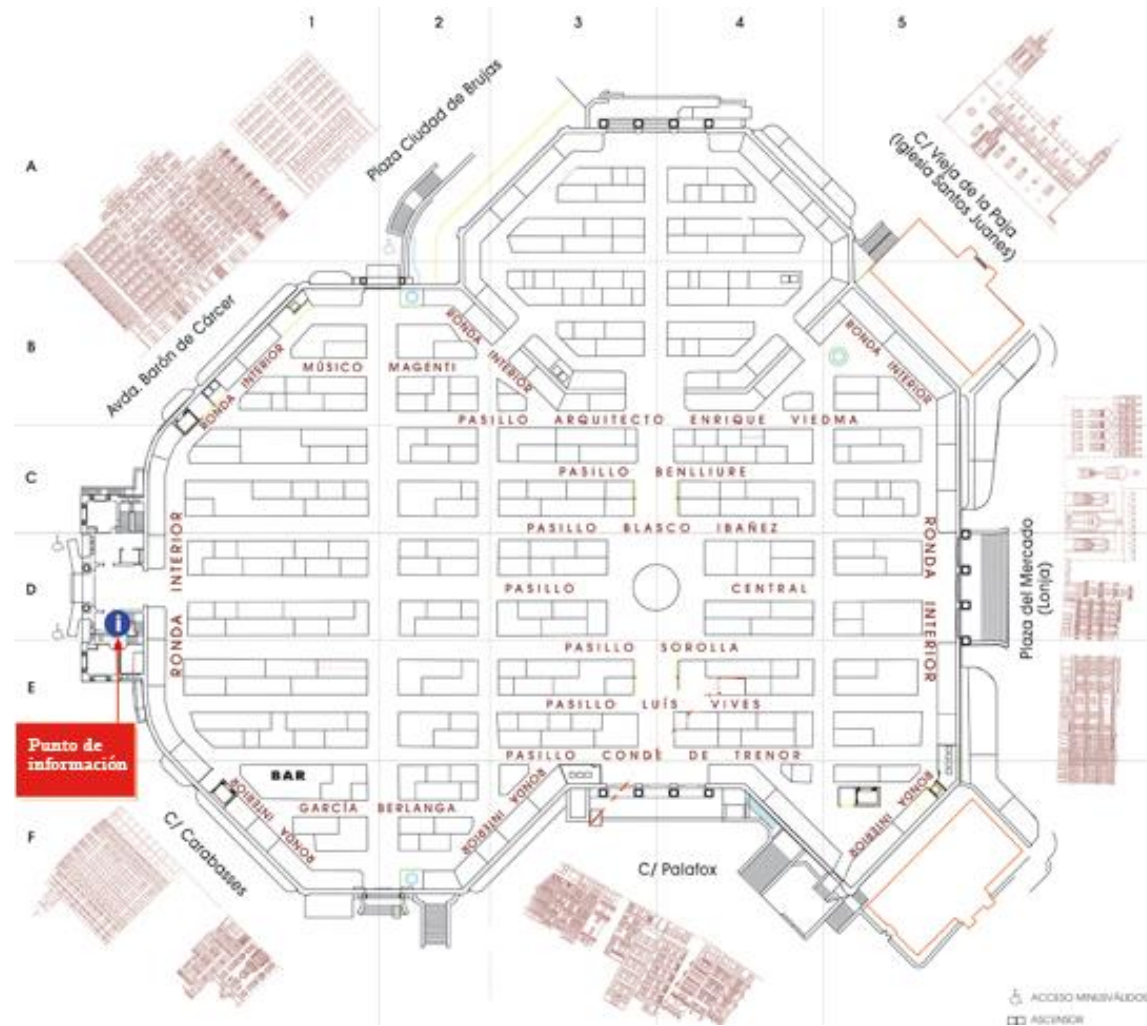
PLANTA ARQUITECTÓNICA MERCAT CENTRAL VALENCIA.
